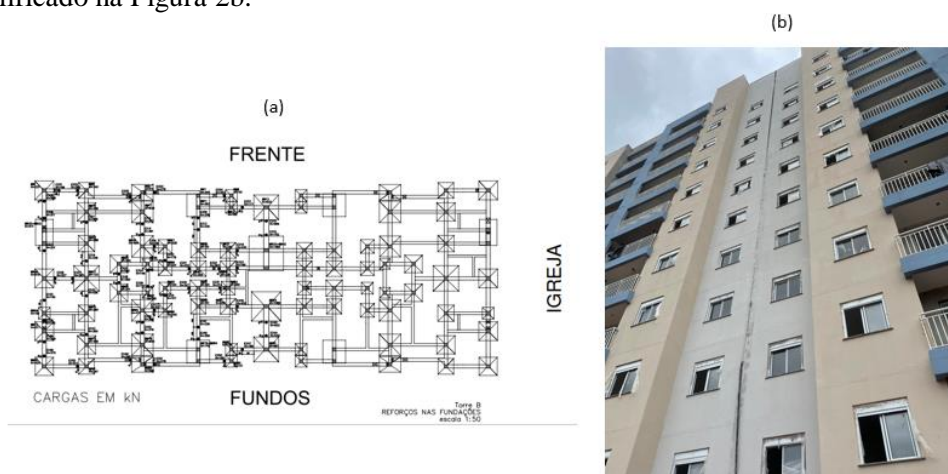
Projeto de Fundações em sapata (a). Vista parcial do empreendimento executado (b)
